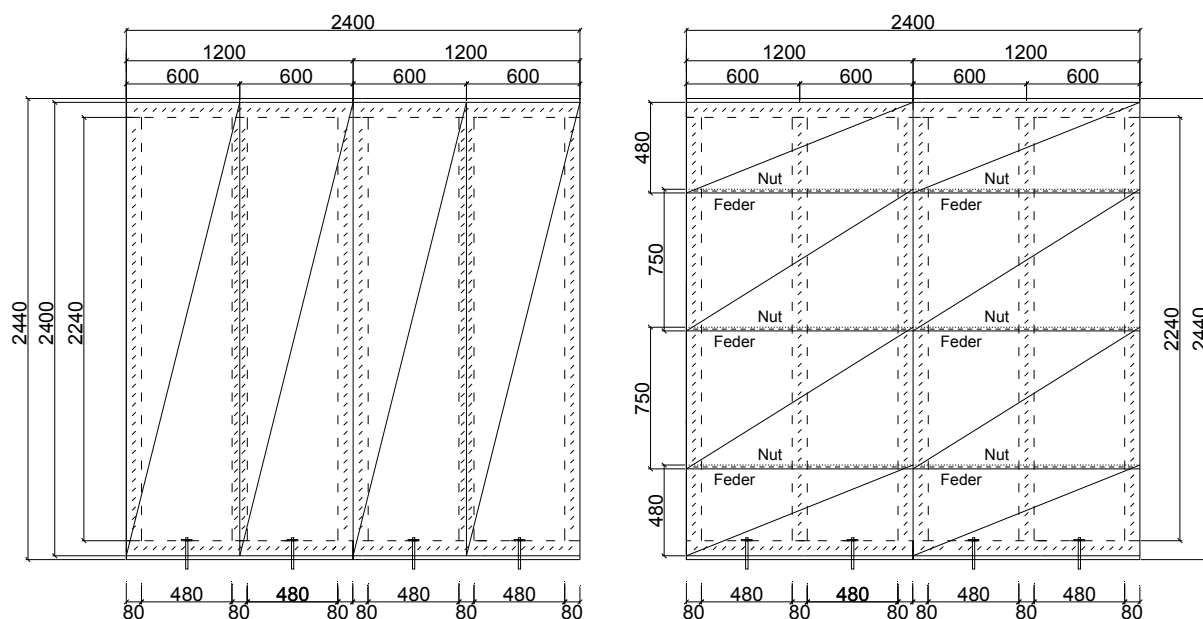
Aufbau der Wandscheiben mit Beplankungsstößen (Maße in mm)
